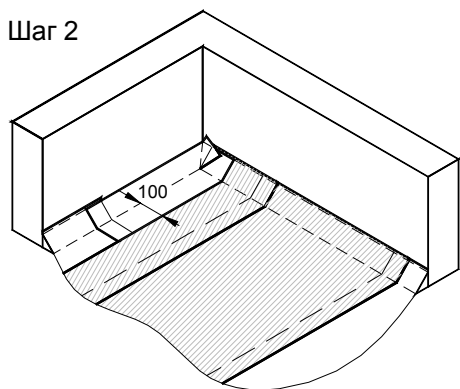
Примыкание кровельного ковра к парапетной стене с парапетным камнем.
